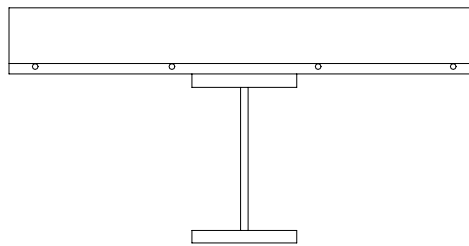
Esquematização da seção transversal da viga mista, HUANG et al. (1999).
